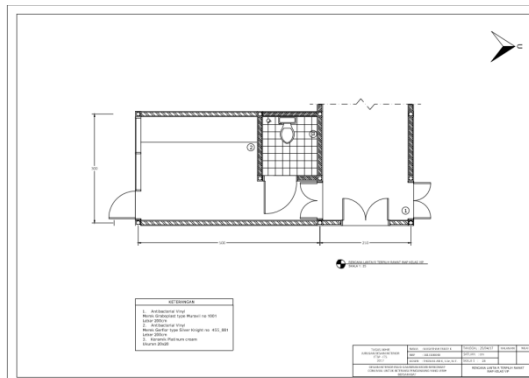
Layout ruang terpilih kamar rawat inap kelas VIP
